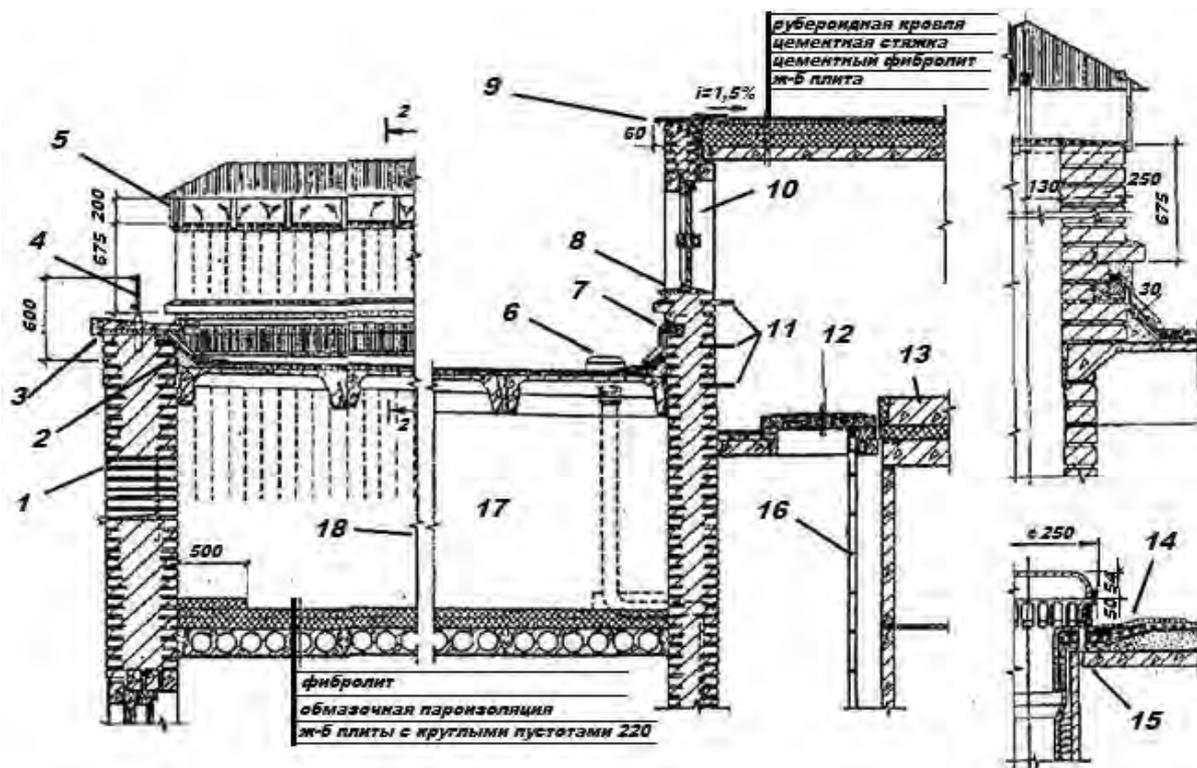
Крыша с внутренним водостоком, опирающаяся на поперечные стены:
